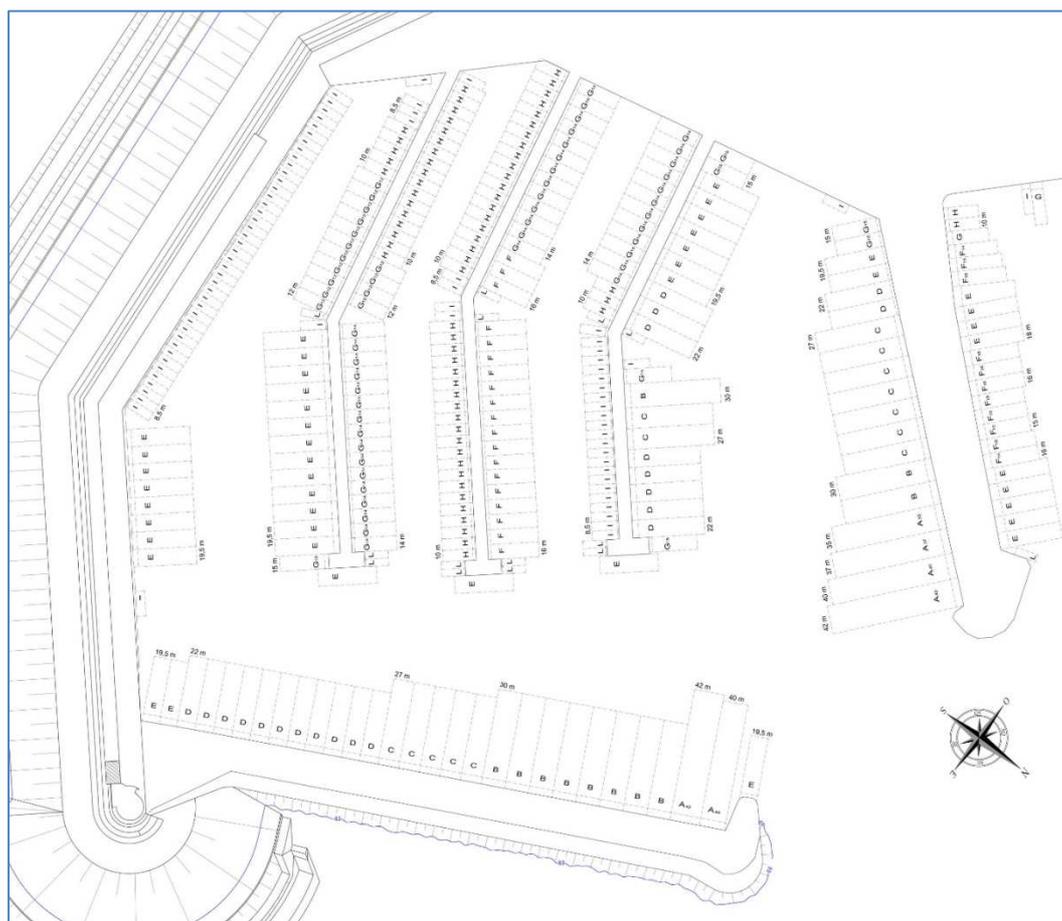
Ricostruzione dell'assetto tipico del layout portuale ante-mareggiata
